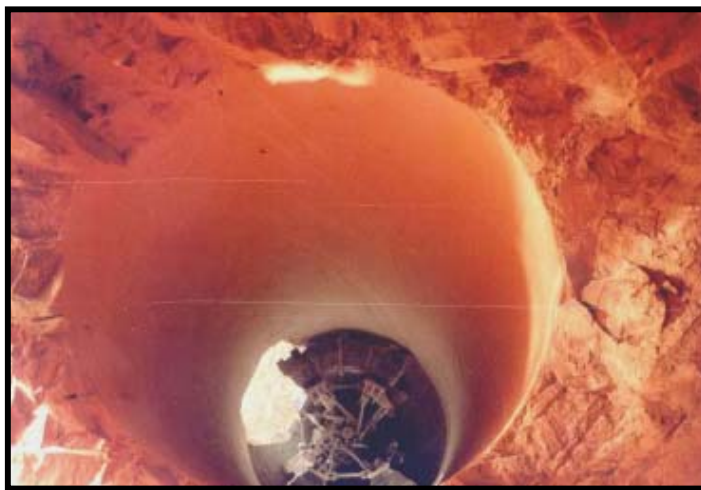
Acabado en el rimado para la construcción de los pozos de oscilación
